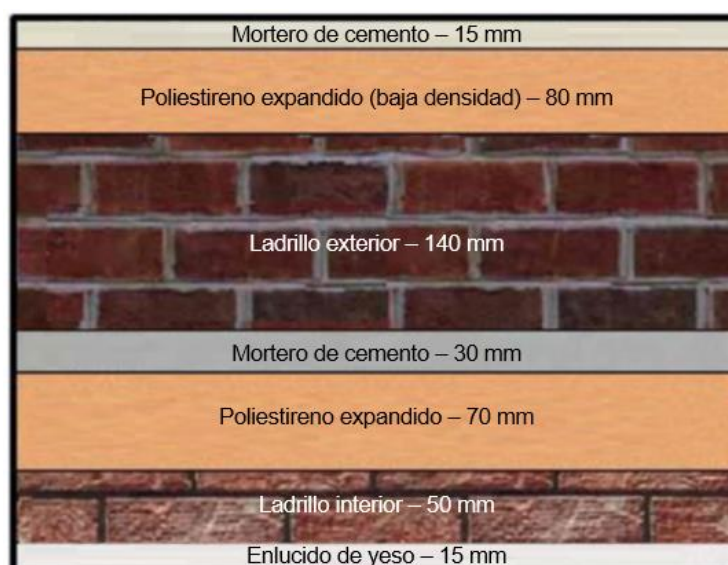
Composición por capas de la fachada de la vivienda tras aplicación de todas las medidas. Fuente: DesignBuilder.
